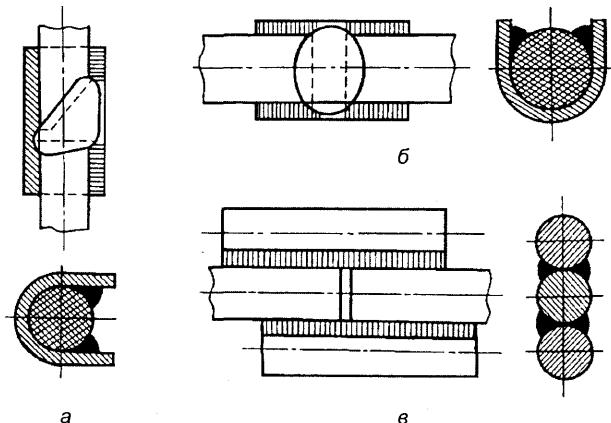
Сварка стыков арматуры железобетона:
